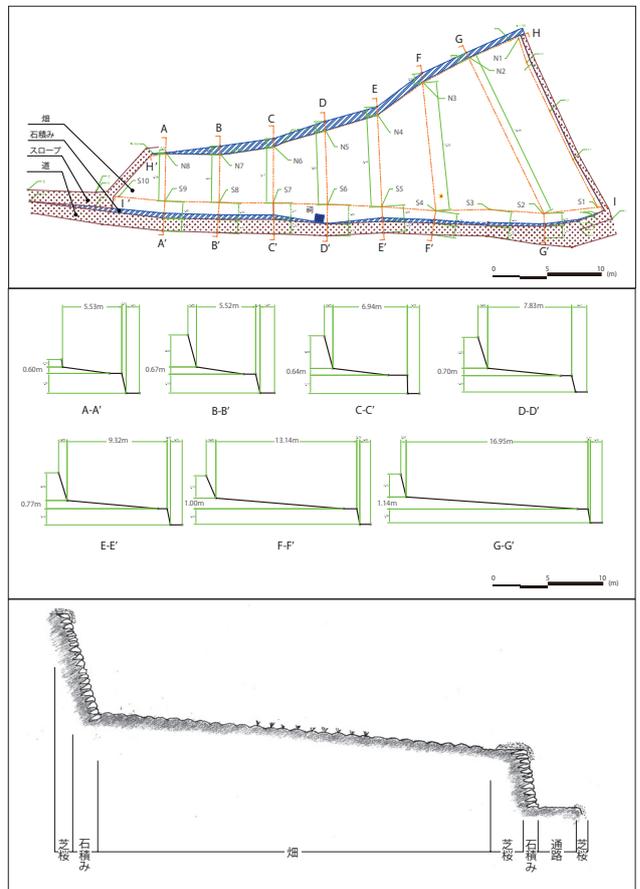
,14,15 上から、平地の平面図, 平地の断面構成図
